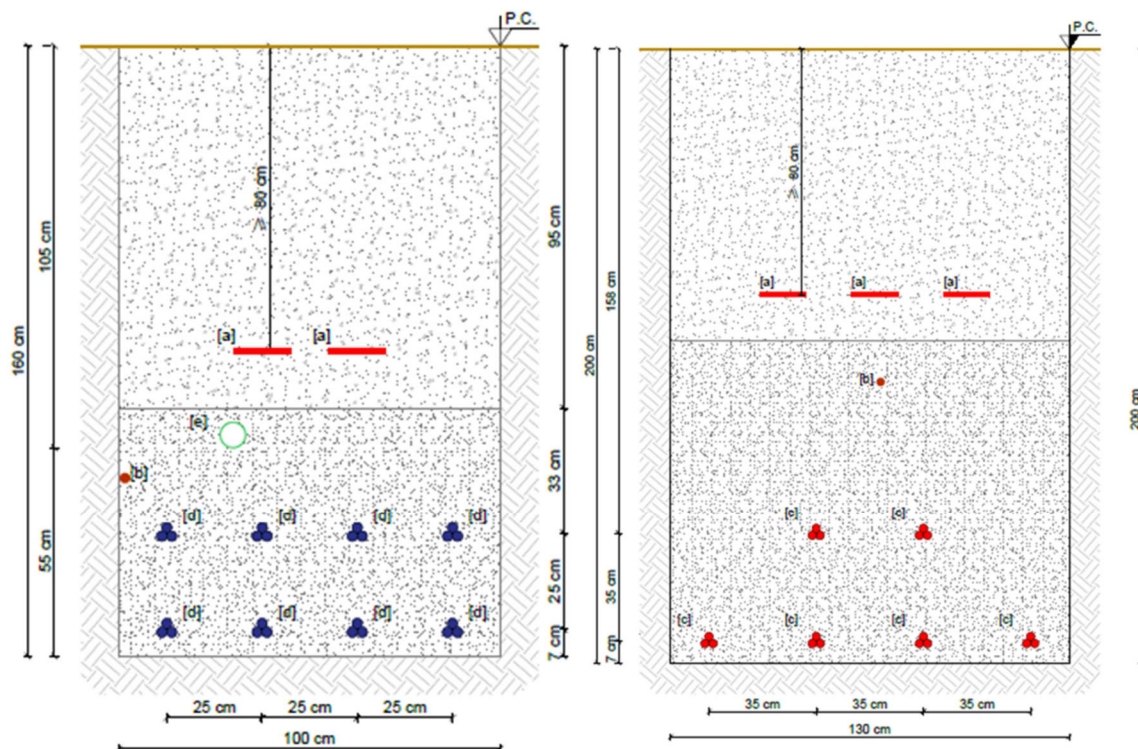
tipologia sezione scavo posa cavidotti BT e AT
